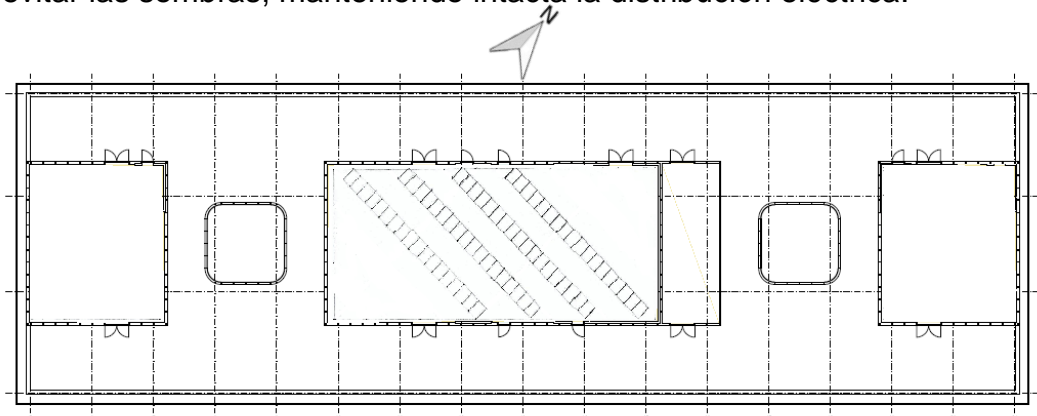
Plano de la propuesta de optimización de la instalación existente
